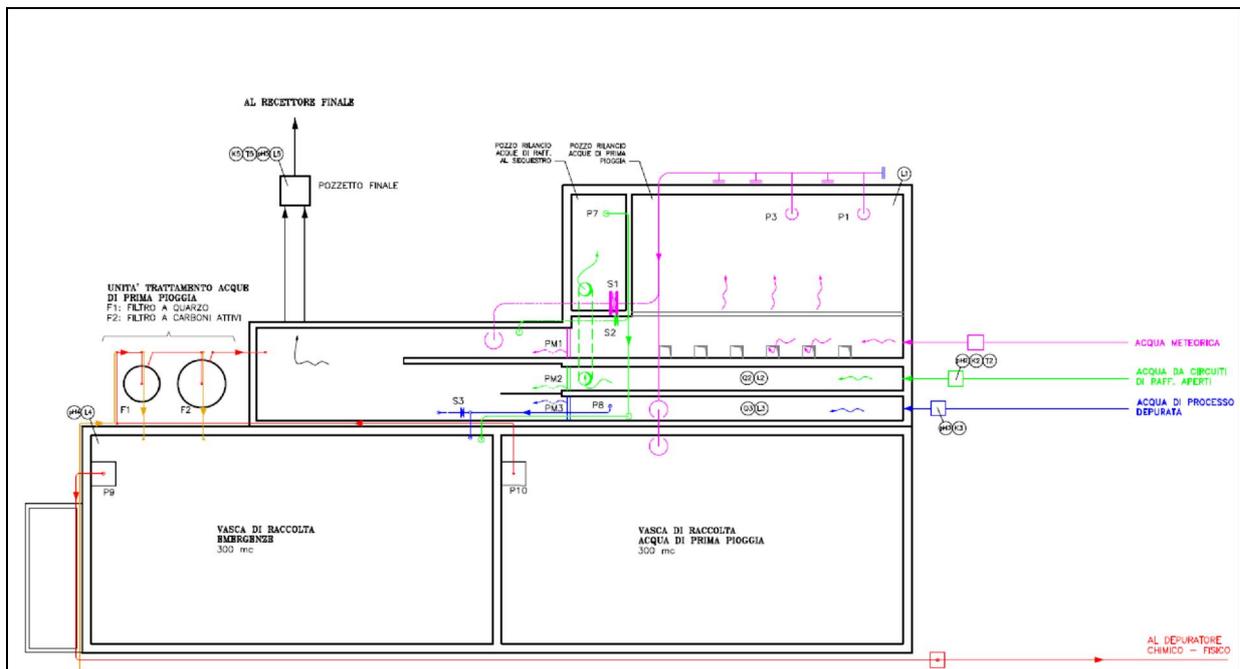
Planimetria delle vasche di raccolta delle acque meteoriche
